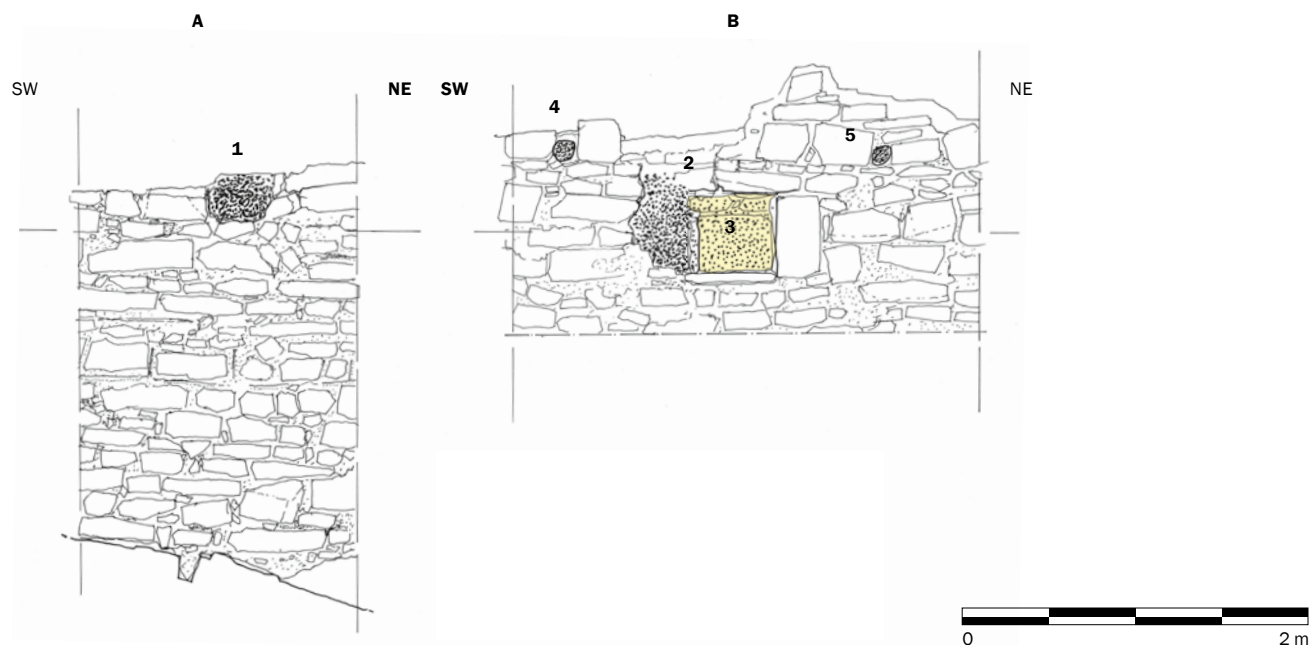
Locale J, muro M10. Dettaglio con tracce della distruzione del 1402.
